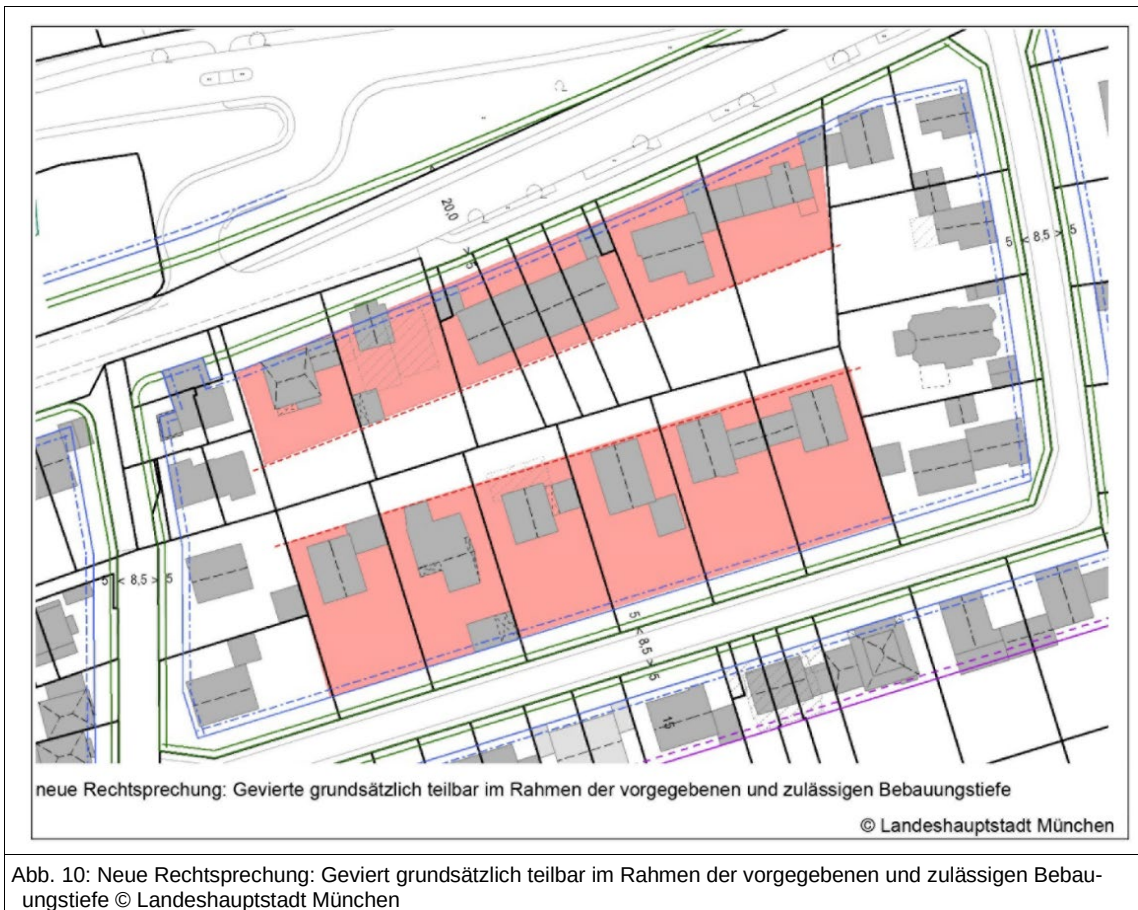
Neue Rechtsprechung: Geviert grundsätzlich teilbar im Rahmen der vorgegebenen und zulässigen Bebauungstiefe © Landeshauptstadt München
